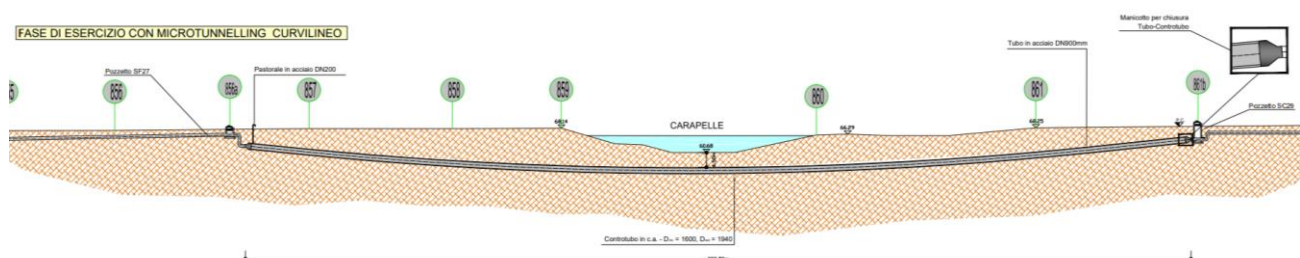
Sezione attraversamento mediante microtunneling Torrente Carapelle
